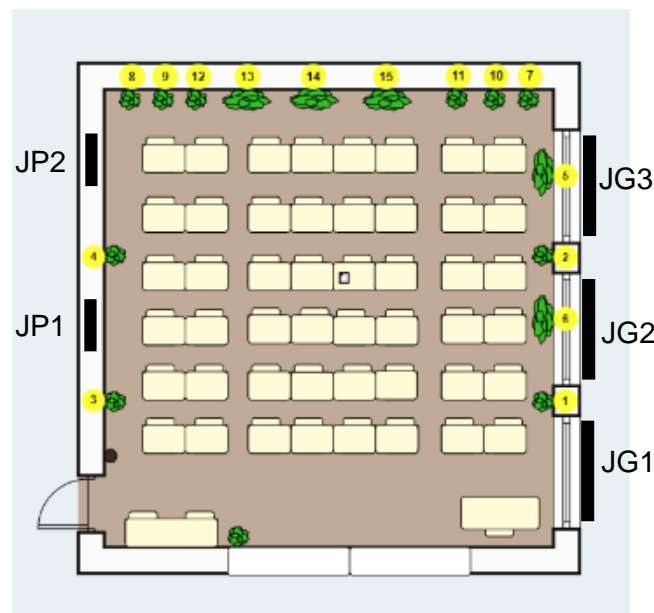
Planta da SV, indicação das plantas e do aparelho de medição da QAI ao centro da sala
